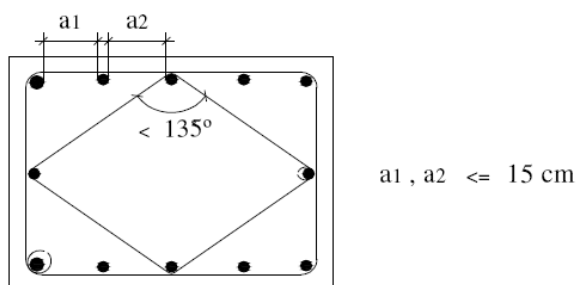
Pormenorização armadura transversal (Nova Faceta)
